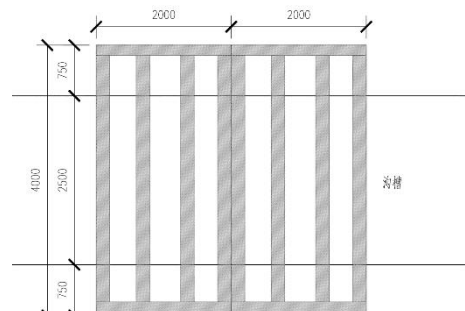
加劲肋平面布置(沟槽宽度 2.0-2.5m)
